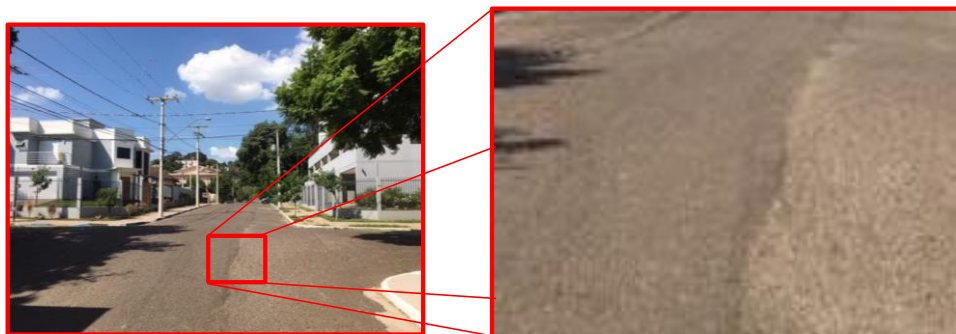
Vias de acesso ao futuro empreendimento com pavimentação regular.
